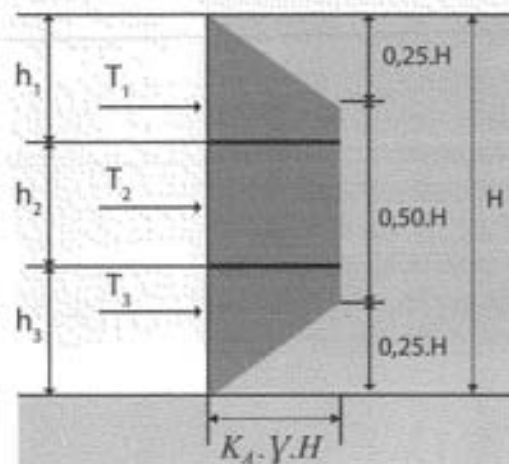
CONSTRUCCIÓN DE TABIQUES Y ANCLAJES ENTRE CONTRAFUERTE
